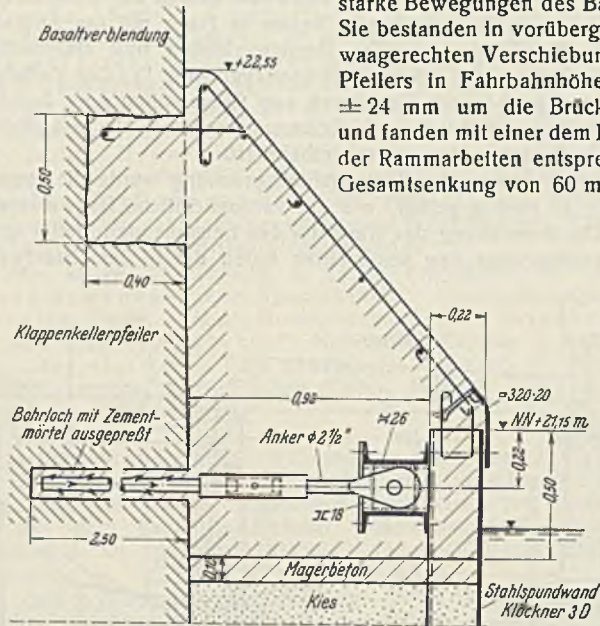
Holmausbildung der Wand vor dem Klappenkellerpfeiler.
